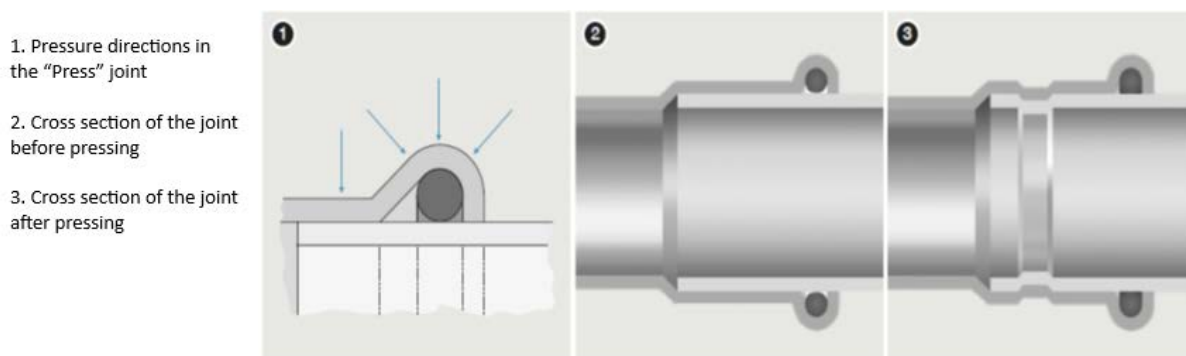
Sezione trasversale di un giunto nel sistema KAN-therm Steel
